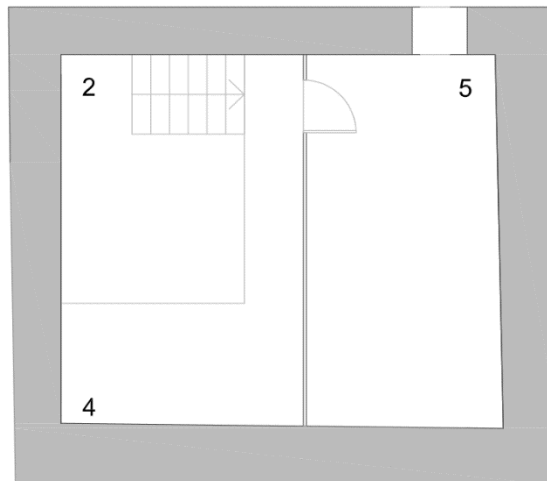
Planta baixa casa de século XVIII en Vilar de Donas
